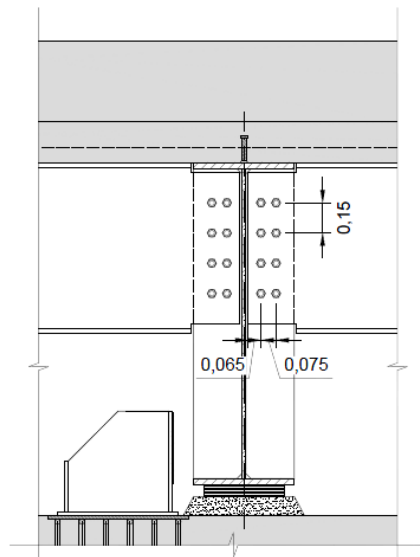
Uniones de vigas transversales- Puente de acceso
